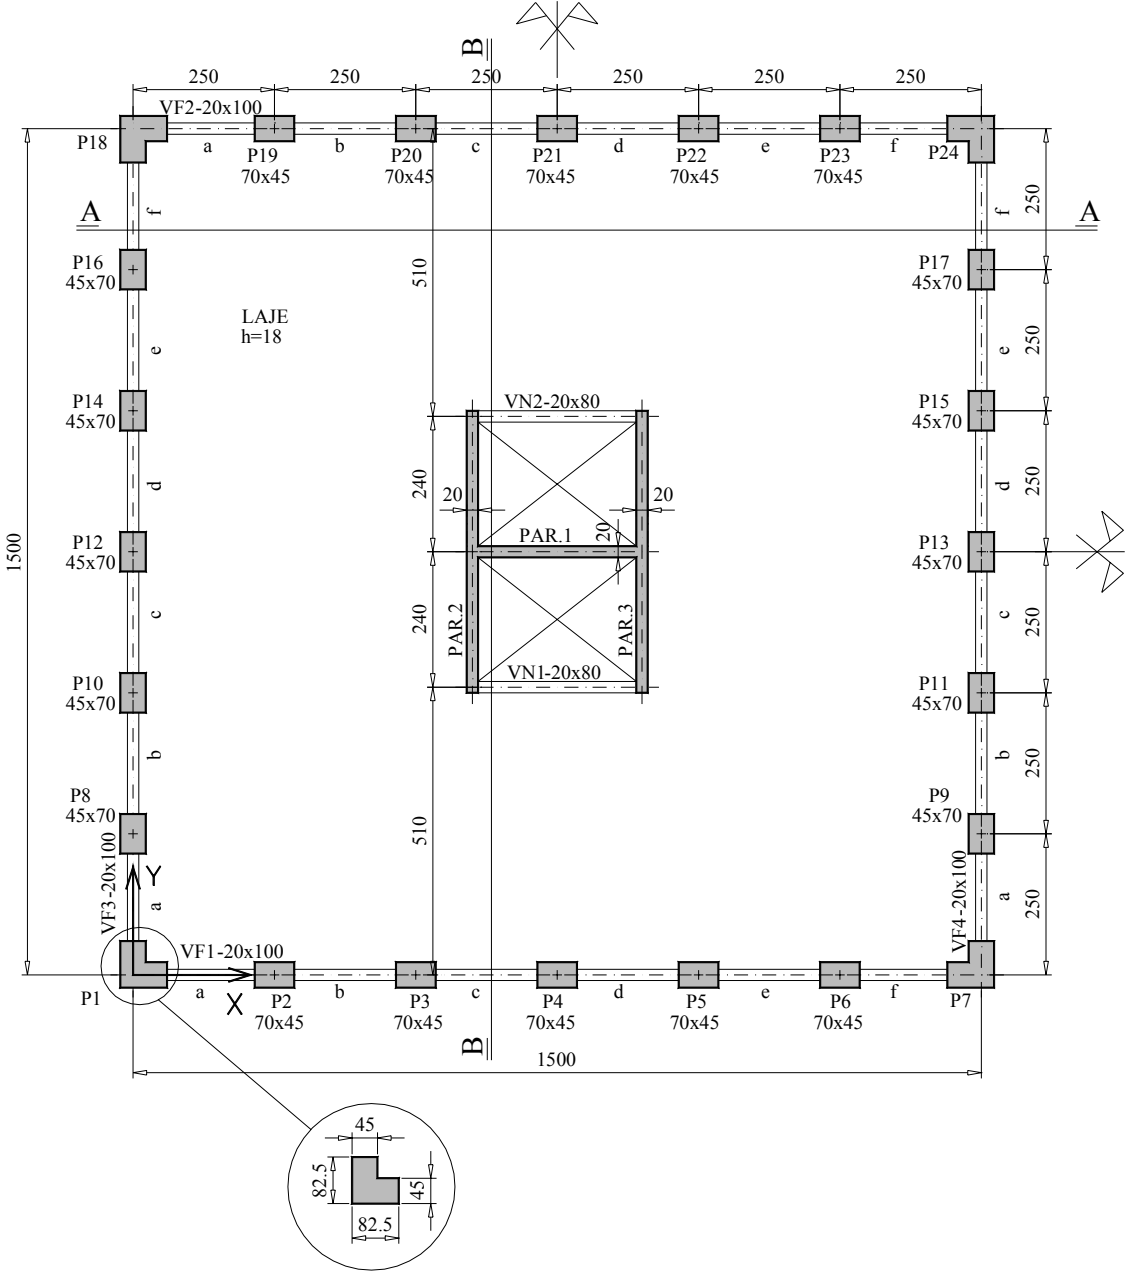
Planta do 2° ao 5° andar (cotas em centímetros)
